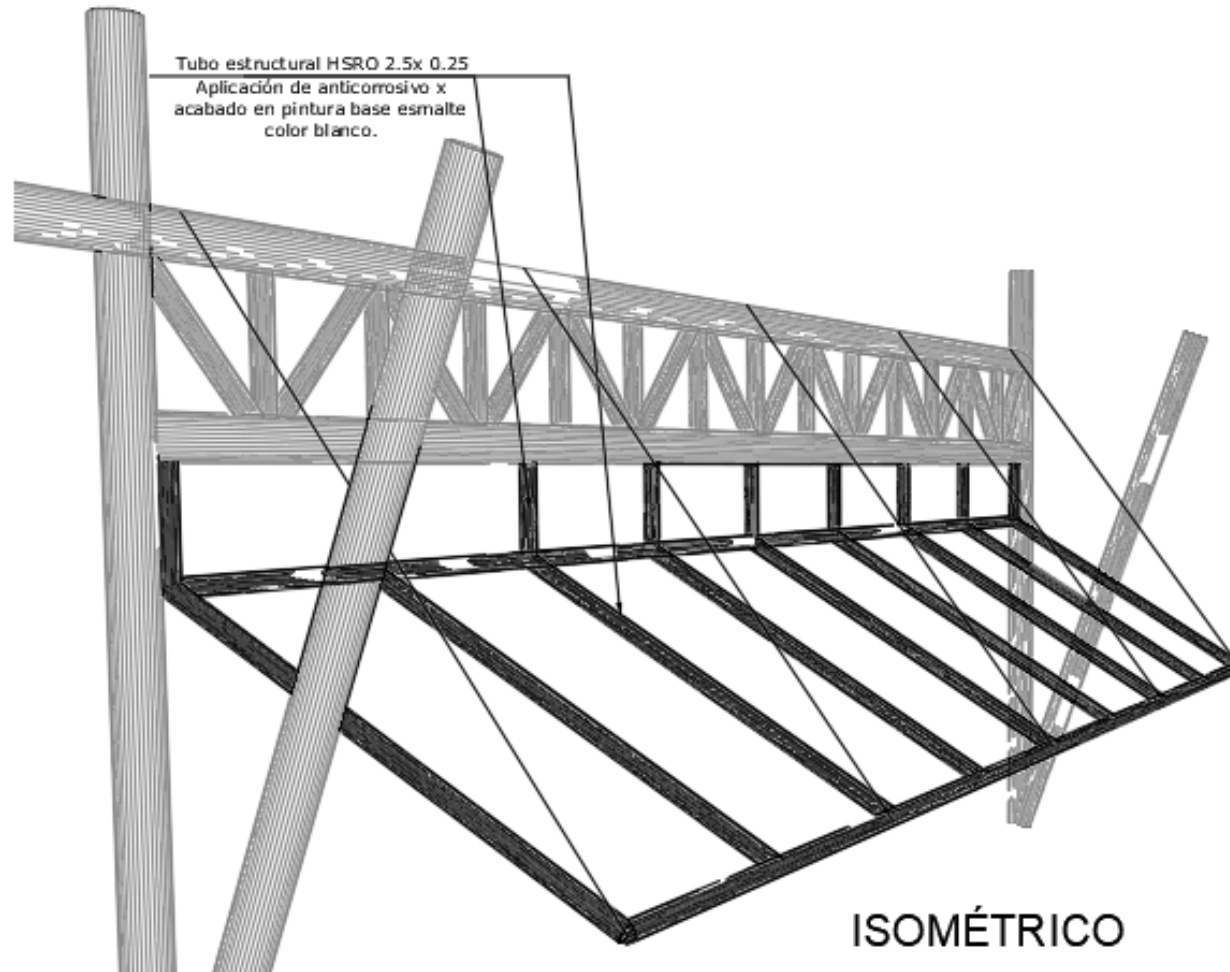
Detalles de columna y vigas metálicas.
